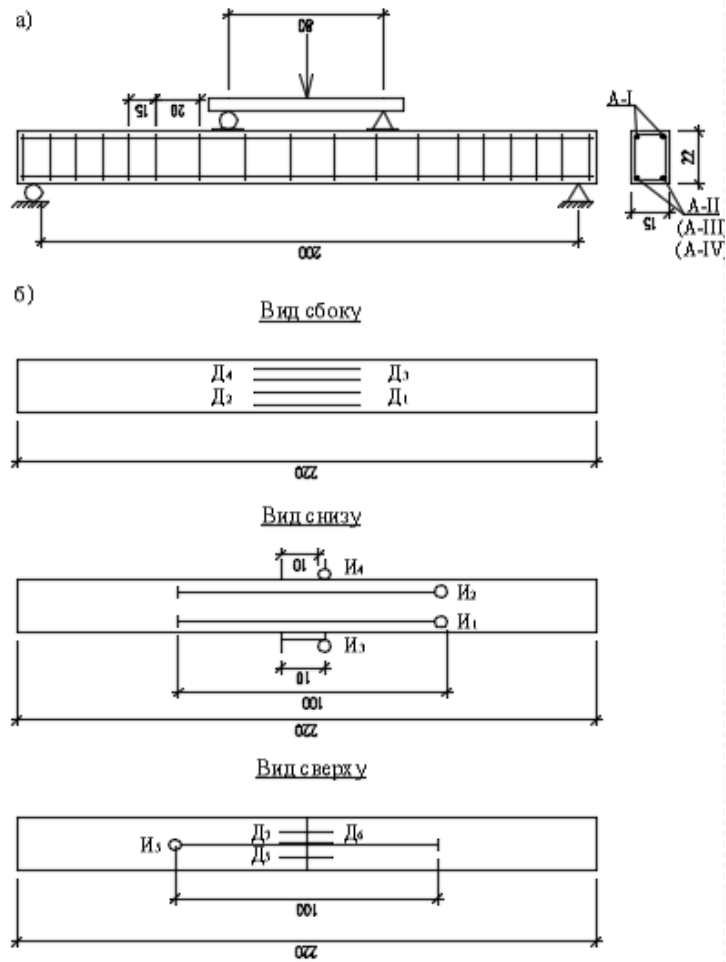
Схема армирования и испытания опытных балок (а) и расположение деформометров и тензодатчиков (б)
